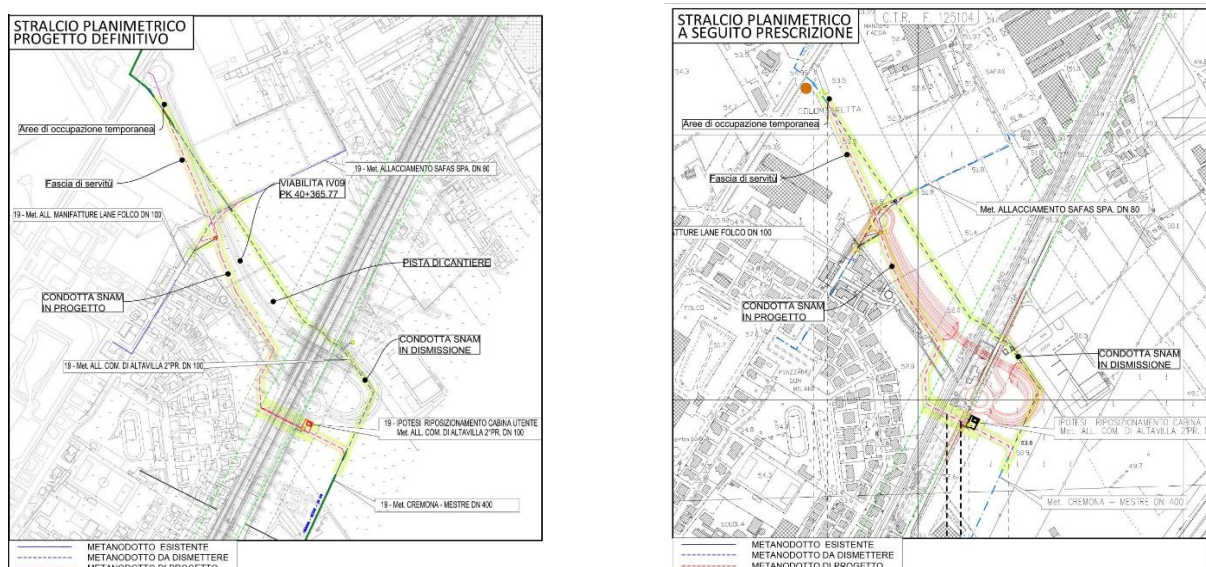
Stralcio planimetrico di progetto definitivo ed esecutivo
